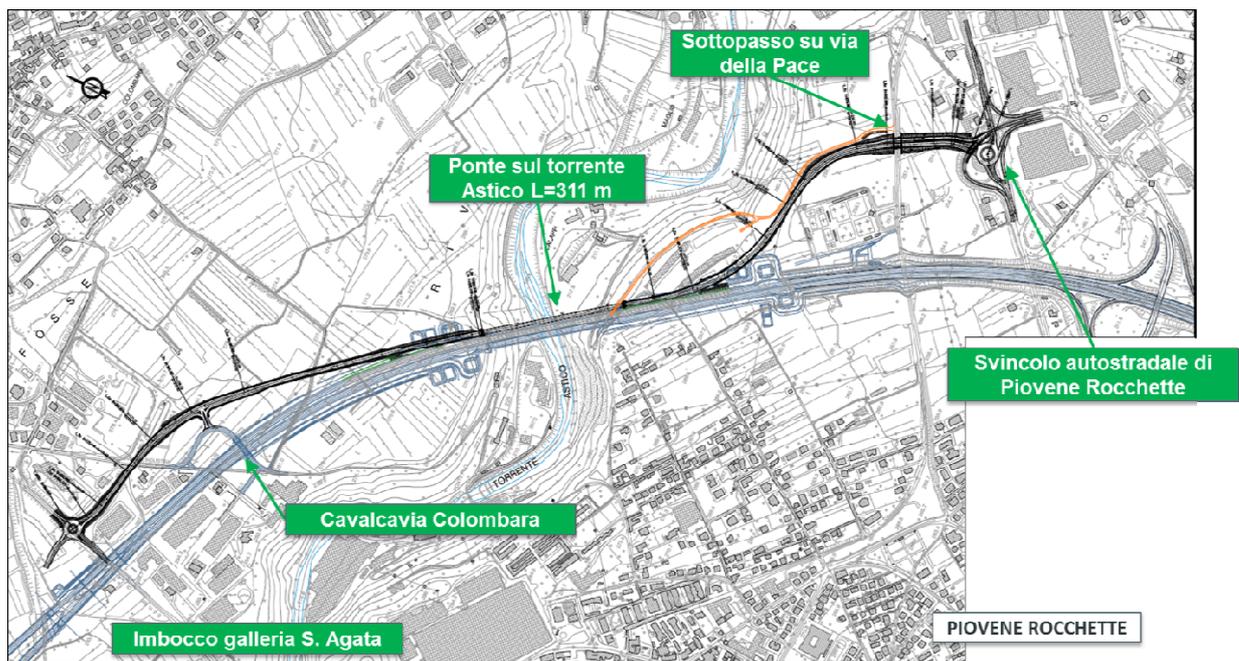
Planimetria della bretella tra Piovene Rocchette e Cogollo del Cengio
